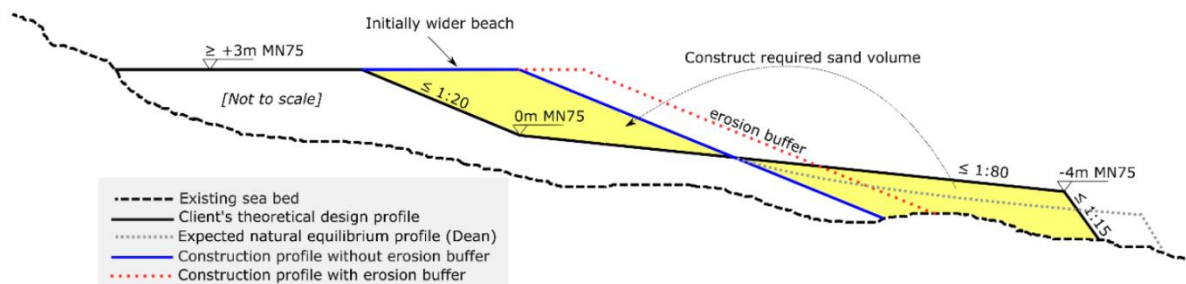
Definiția profilului de proiectare și a profilului de construcție
